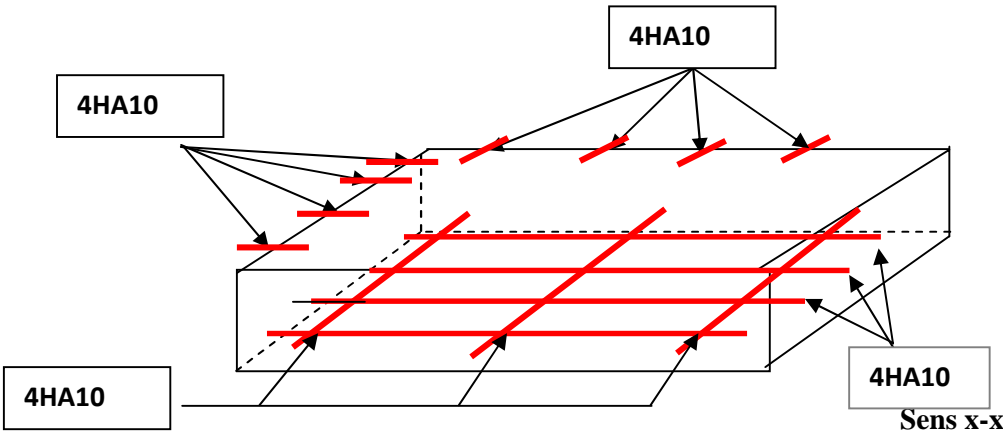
schéma de ferrailage de la dalle d'ascenseur
